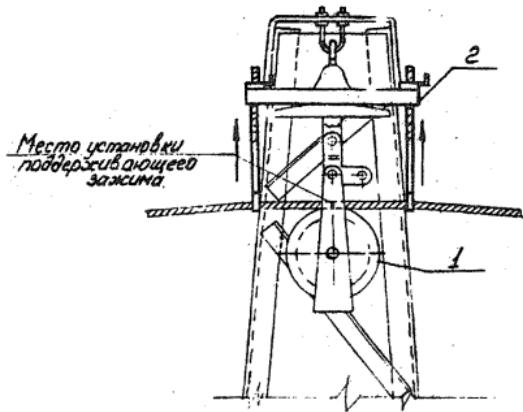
Узел „А“ Герекладка проводов верхней траперсы с опусканием на нижнюю траперсу опоры.
